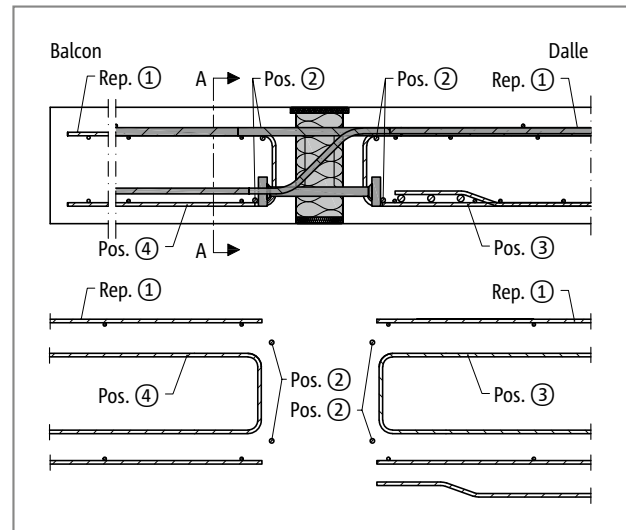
Schöck Isokorb® T Type K-M12 : Renforcement sur site pour support indirect
